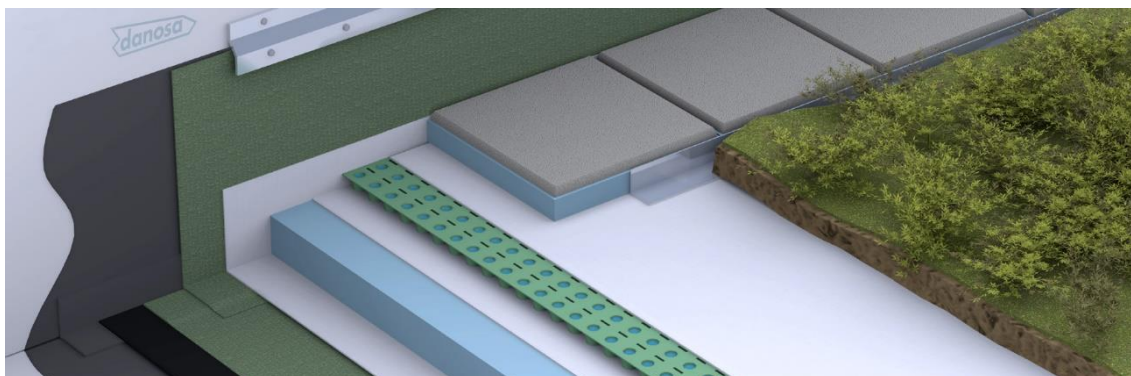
Cubierta plana ajardinada extensiva con LBM.
